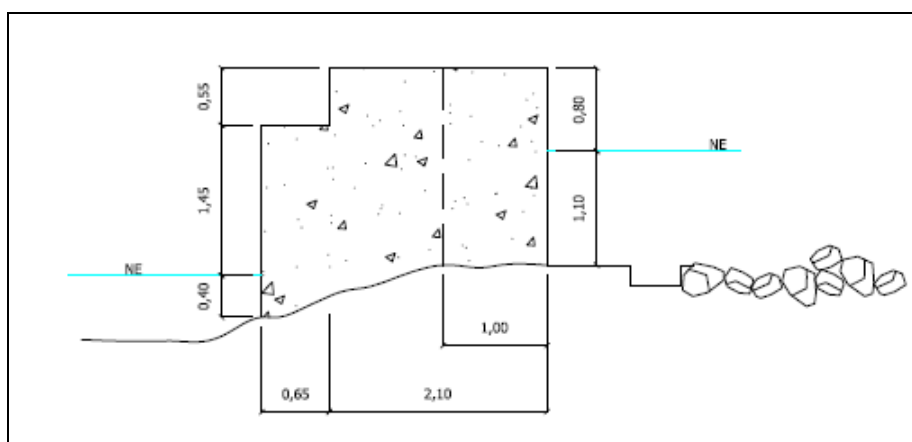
Pile intermédiaire – coupe (techsub 2005)
